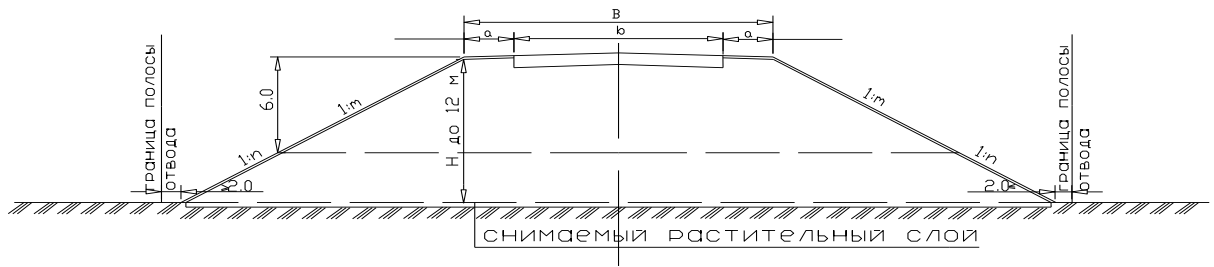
Поперечный профиль насыпи с высотой откоса до 12,0 м
